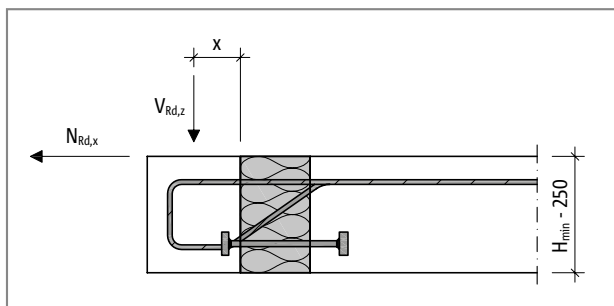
Schöck Isokorb® XT Typ O: Abstand des Lasteinleitungspunktes x (Lastabstand)
